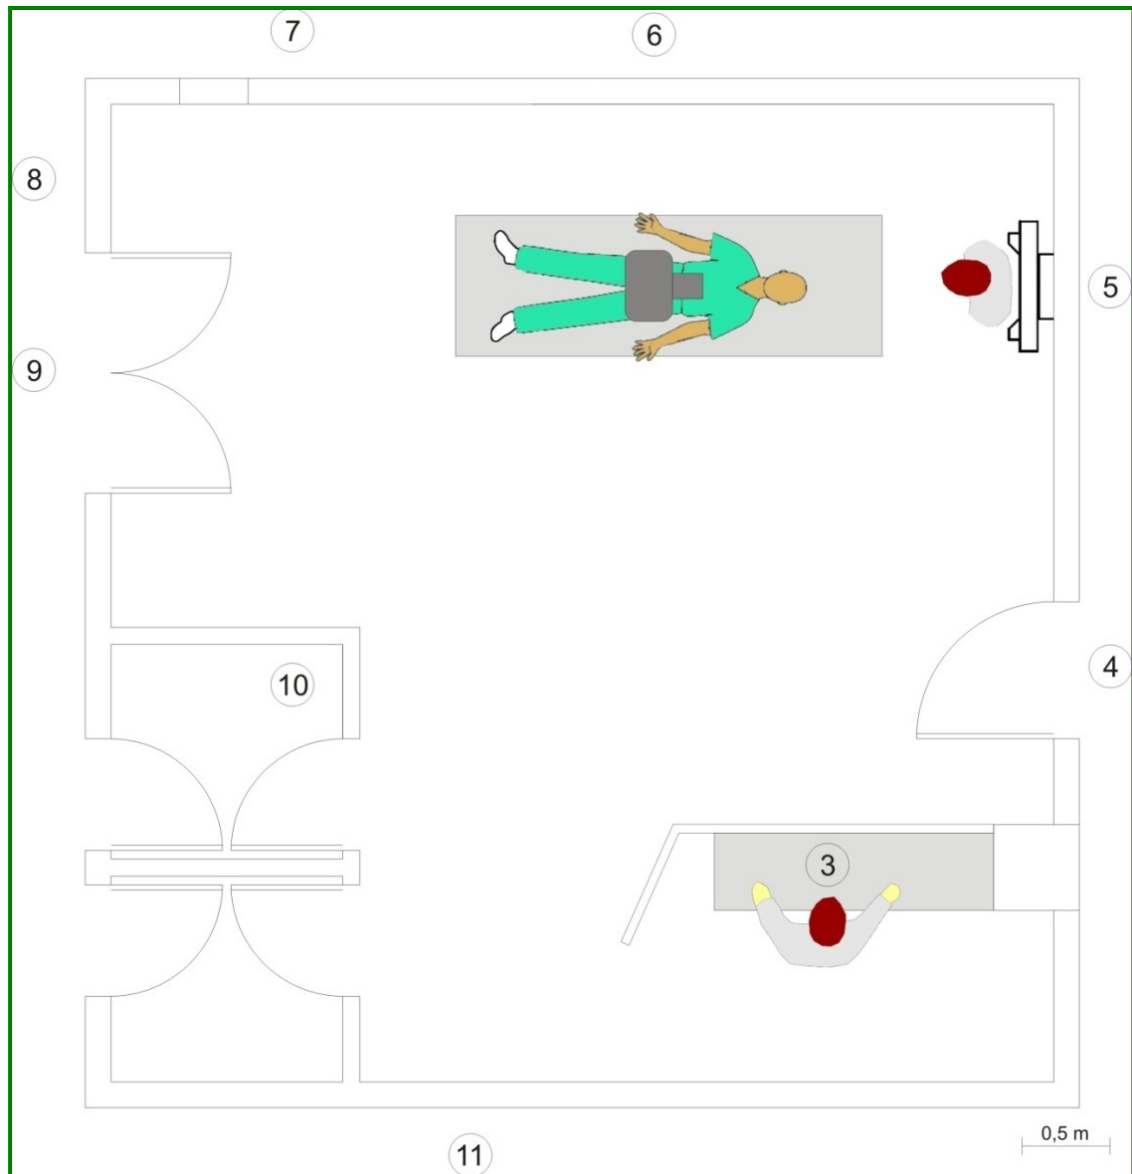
Planta arquitectónica da sala de Radiologia Convencional (Sala 2).
